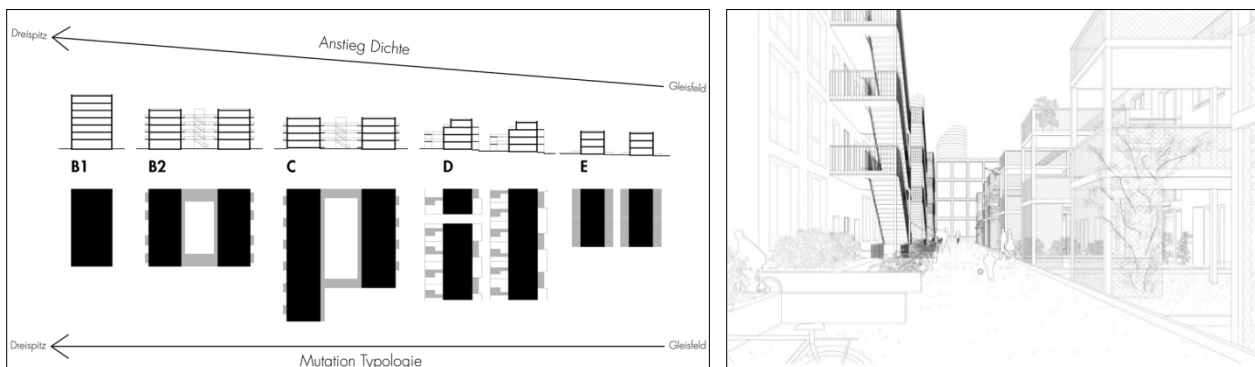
und 6: Erläuterungsskizzen Stand: Abschluss Studienverfahren © camponovo baumgartner architekten gmbh
